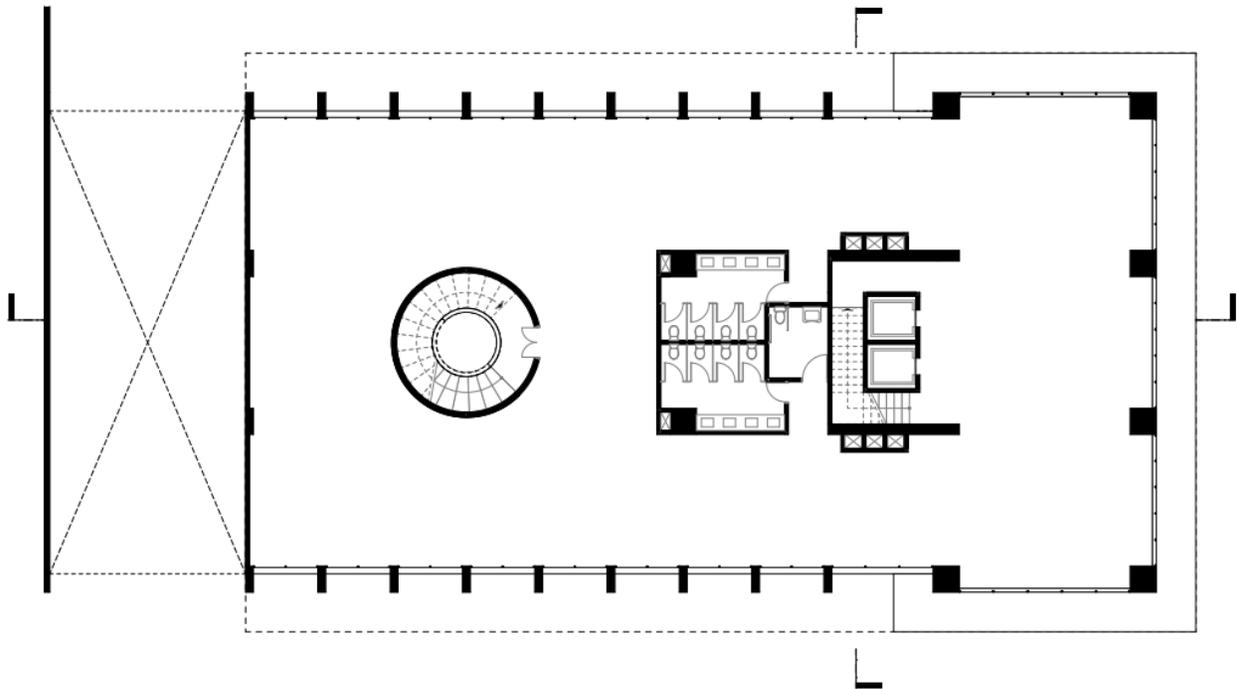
Planta alta original N+3.40. Fuente: Tesistas.
